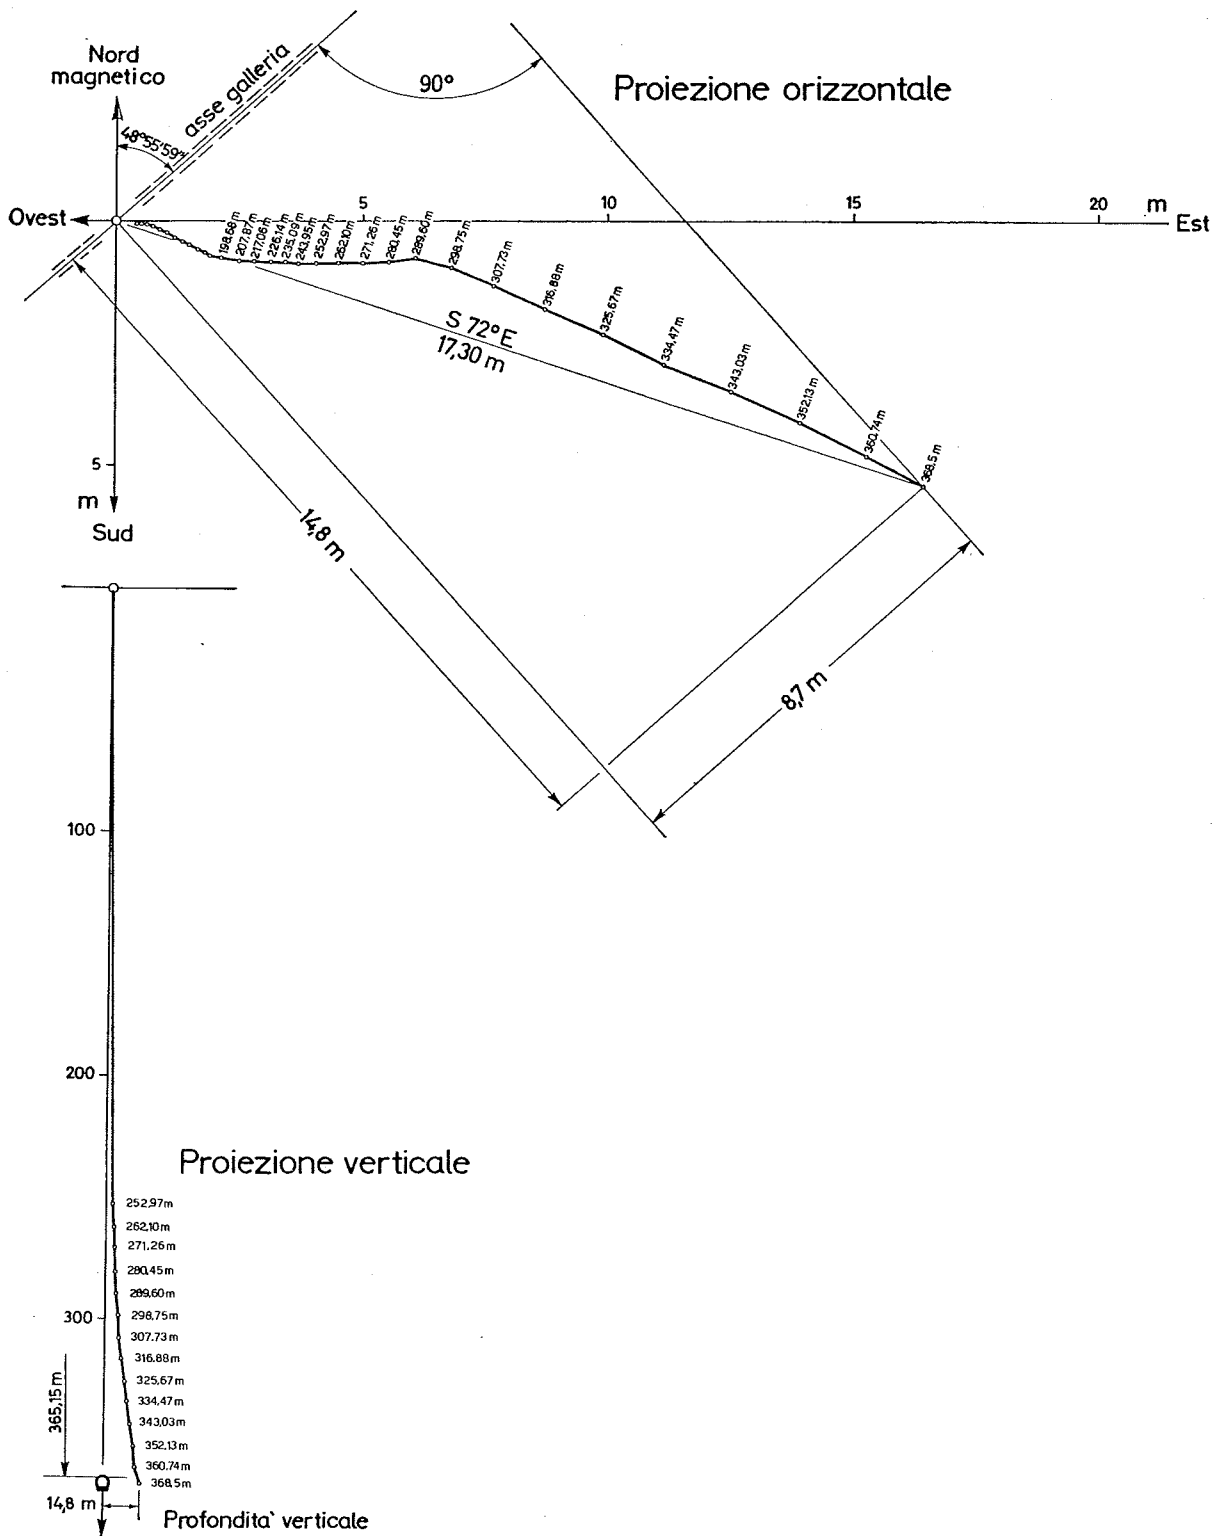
Andamento plani-altimetrico del foro rilevato a mezzo di inclinometro.
